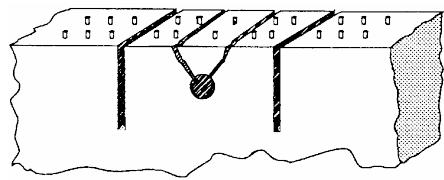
Прессовые инструменты слишком близки к поверхности
